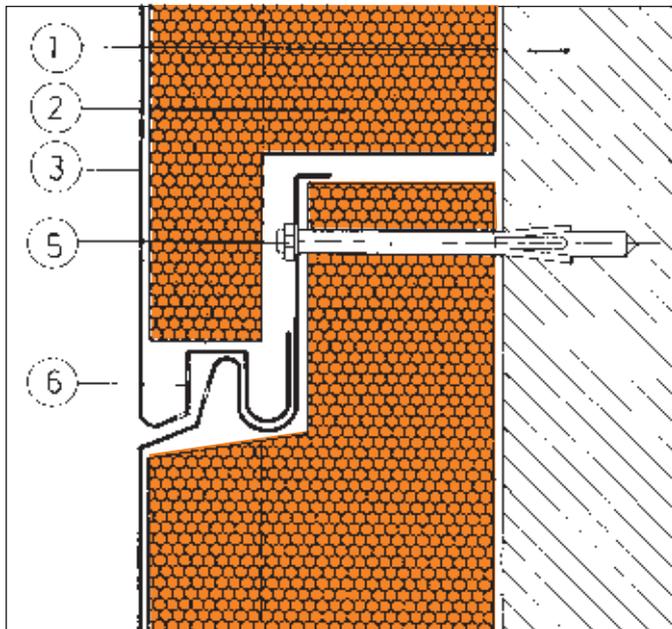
Ancoraggio diretto del rivestimento al supporto - Sezione corrente verticale - giunto orizzontale
